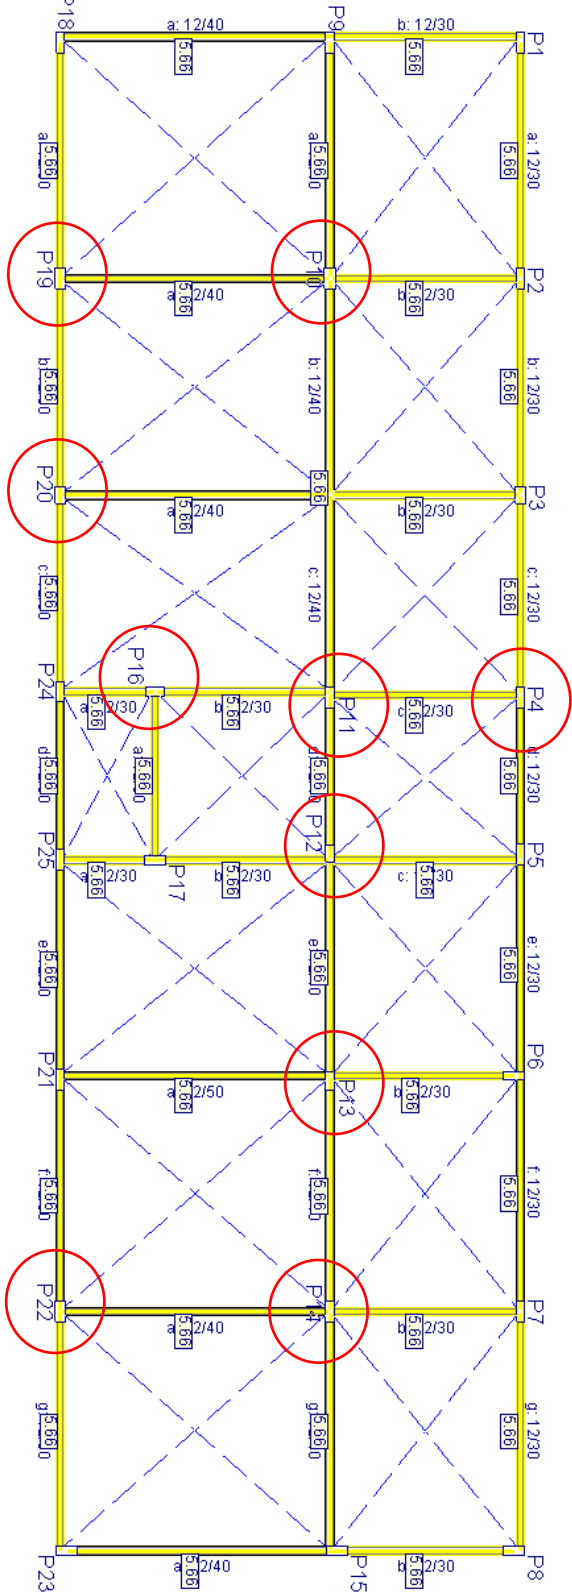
Vista estrutura 3D EPP-4 – 2 pavimentos
